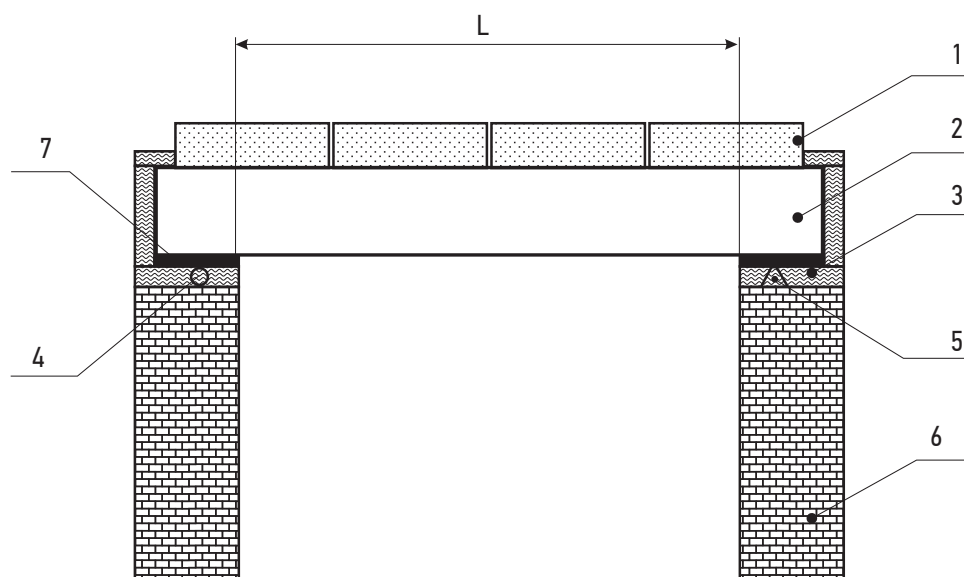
Пример расположения образца балочного элемента при проведении испытаний
